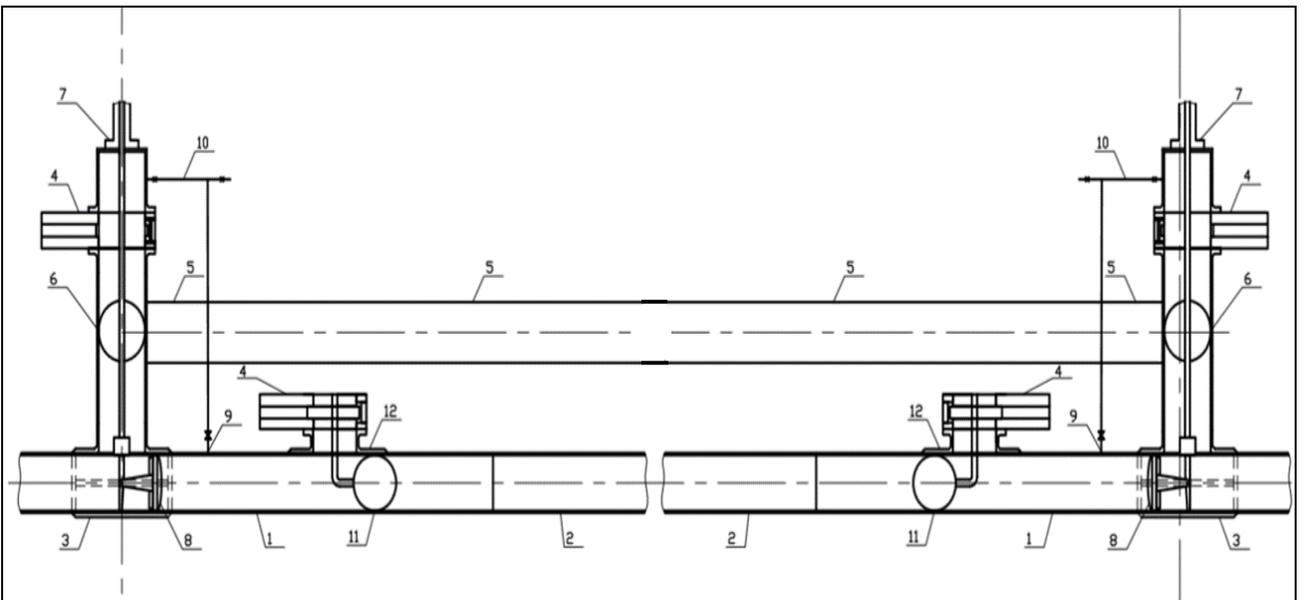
Схема установки оборудования TDW для перекрытия полости конденсатопровода
